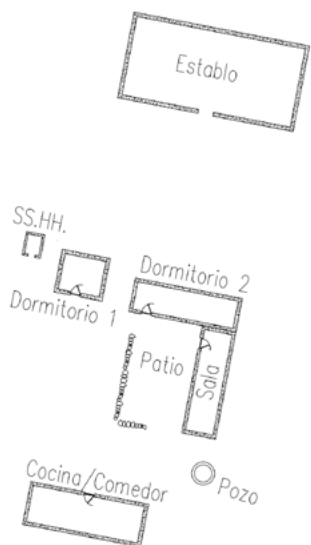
Distribución espacial de la arquitectura vernácula P<sub>02</sub> (-15.663279, -70.152392), con construcciones de adobes y con cobertura de lámina metálica acanalada
